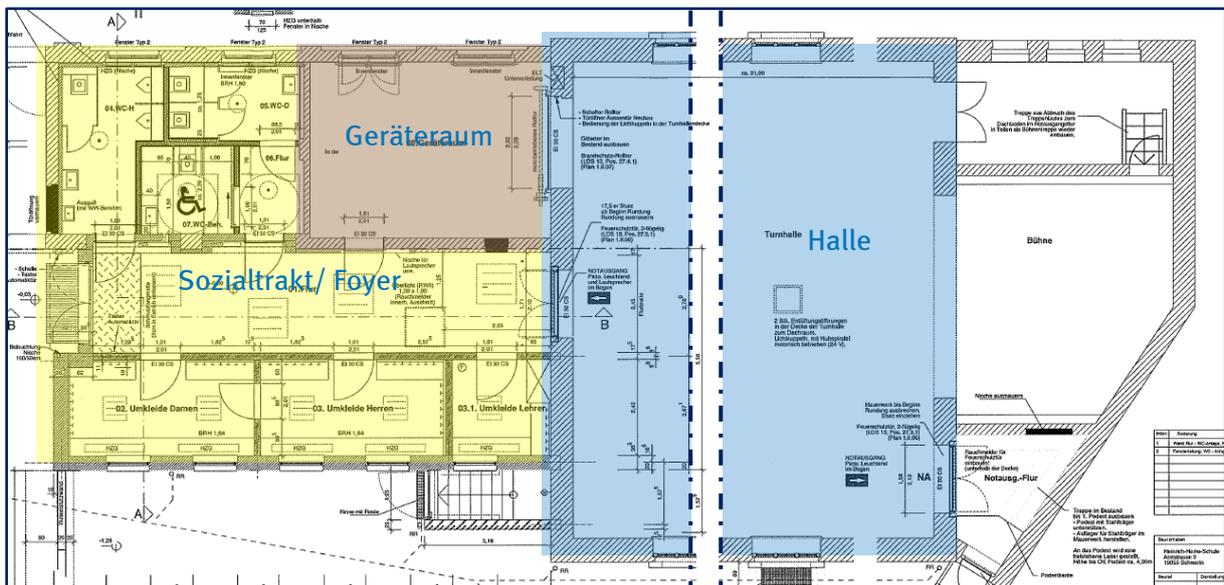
Grundriss TH 5 - (Quelle: ZGM)
